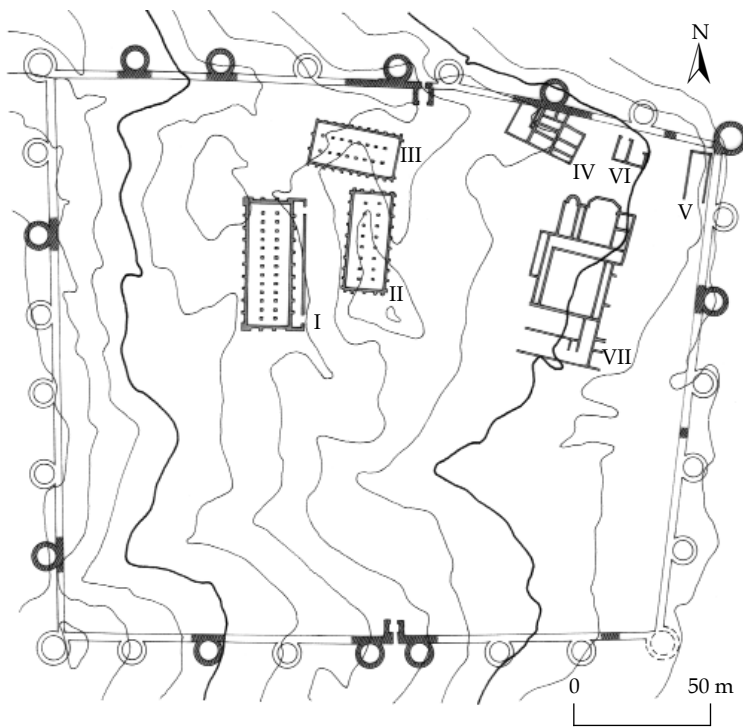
Der rekonstruierte Grundriss der Festung von Ságvár während der zweiten Bauphase mit Innenbauten (I–VII) und Höhenlinien. – Plan: Autor.
